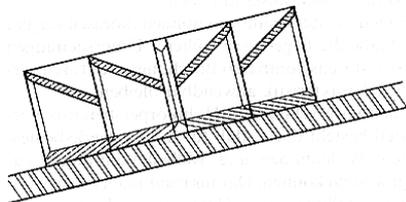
Vertikaler Längsschnitt durch einen Verband von vier Betonformsteinen
